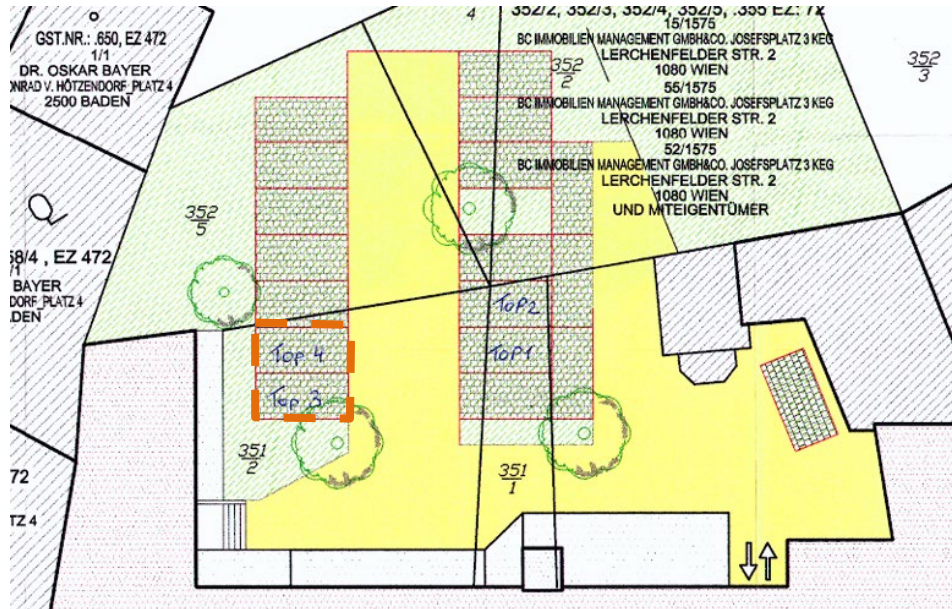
Lageplan mit Verortung der KFZ-Stellplätze (Einreichplan 03.12.2002)
